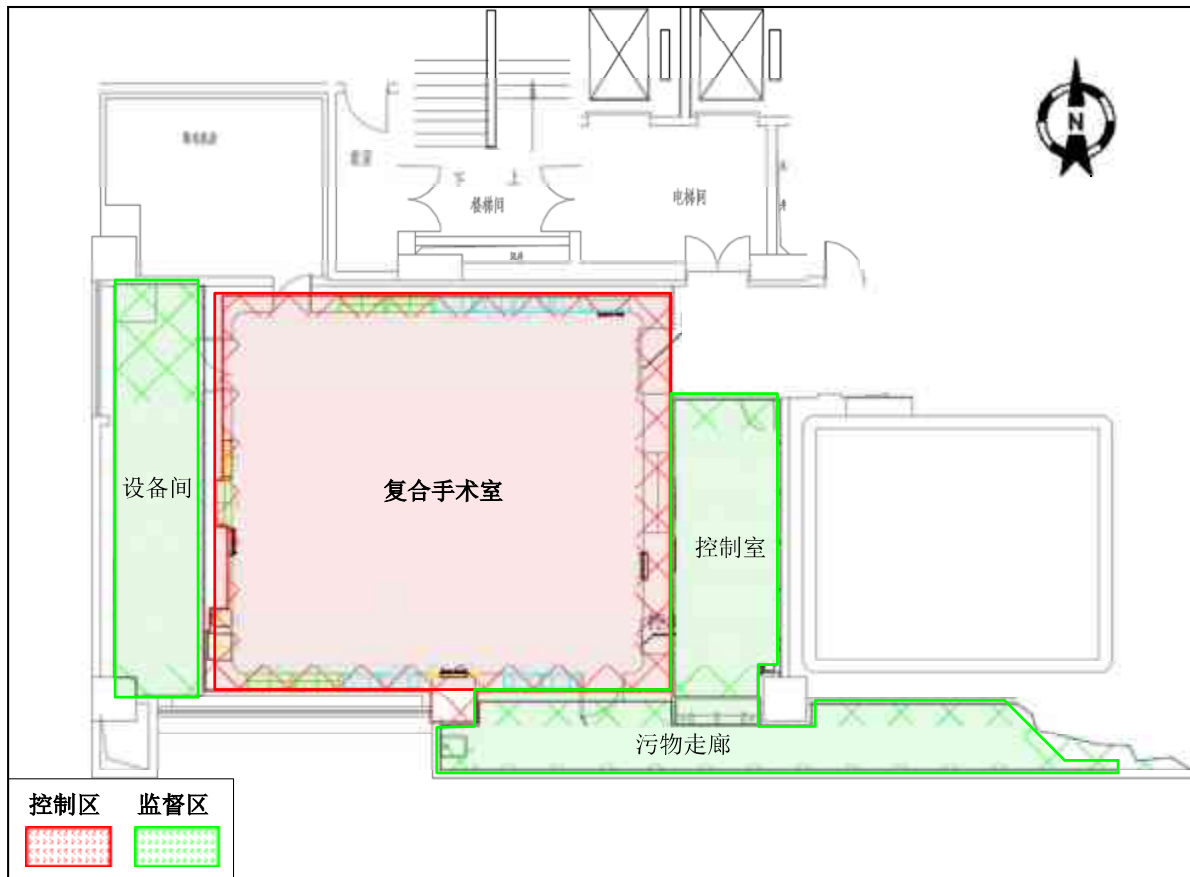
12 号楼四层复合手术室平面布置及分区示意图
